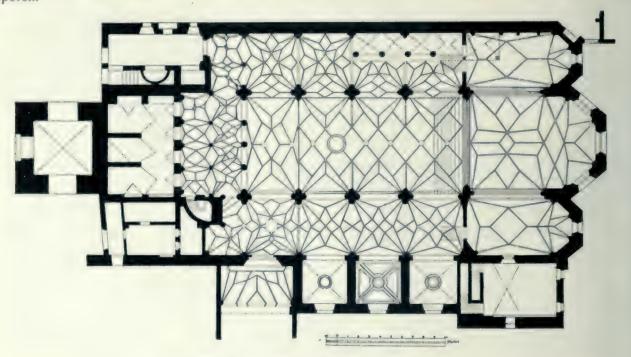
Stiftskirche, Grundriß 1:350 (S. 3)
